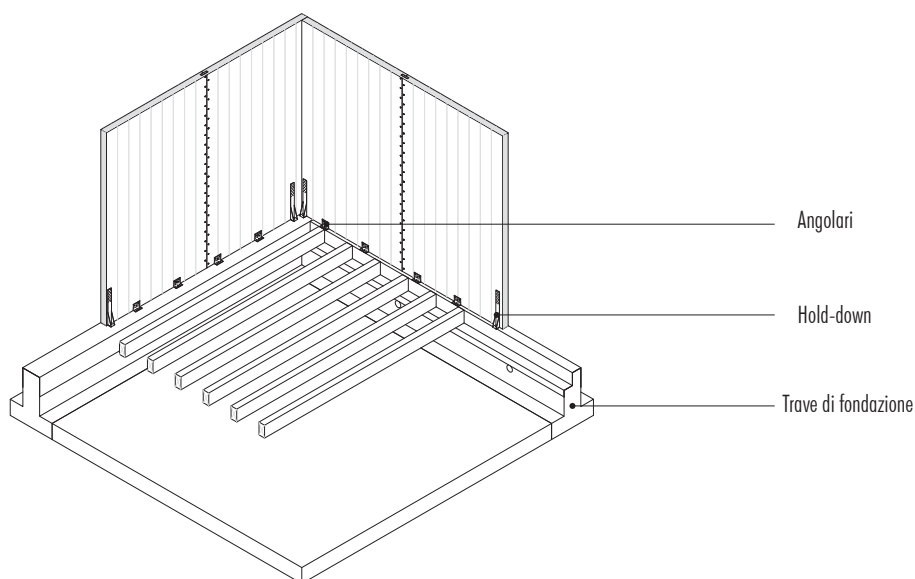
Collegamento alle fondazioni per un edificio XLam con angolari metallici distribuiti e hold-down.
